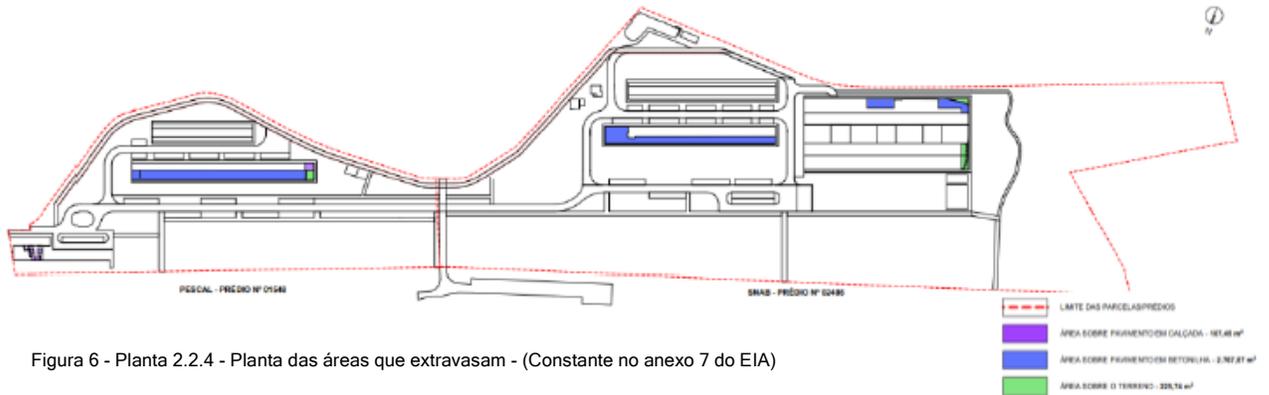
Planta 2.2.4 - Planta das áreas que extravasam - (Constante no anexo 7 do EIA)
